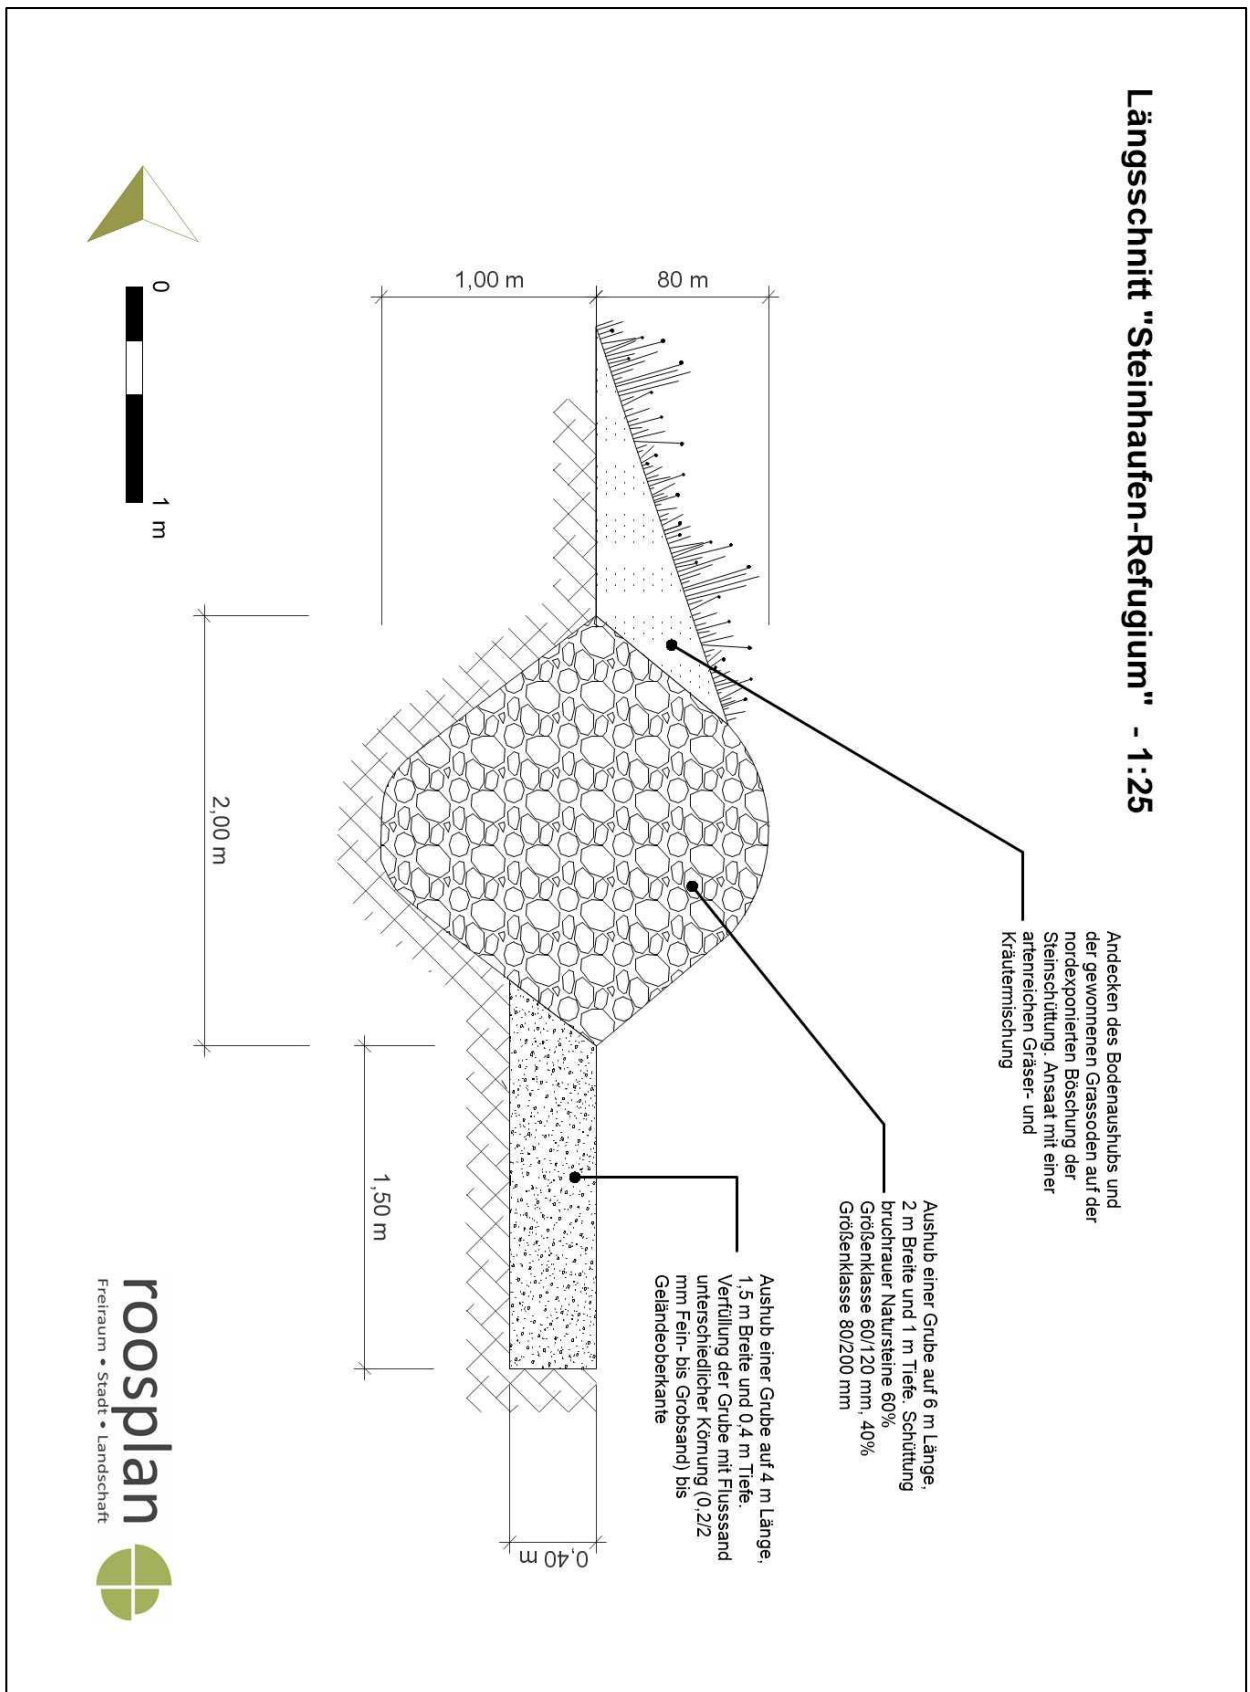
Detailskizze Steinhaufen-Refugium Längsschnitt
